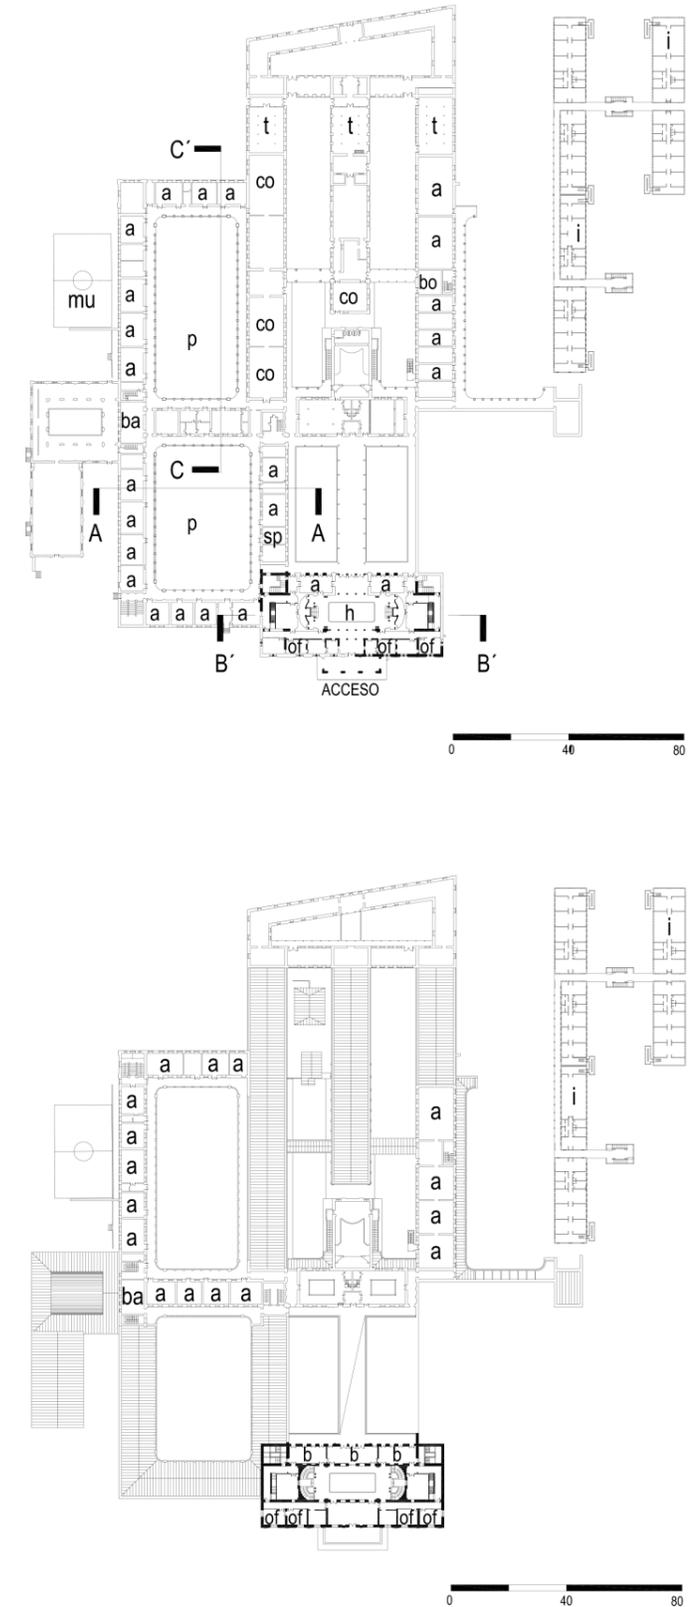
Plantas INBA. “La reconstrucción en Educación”. MINEDUC
